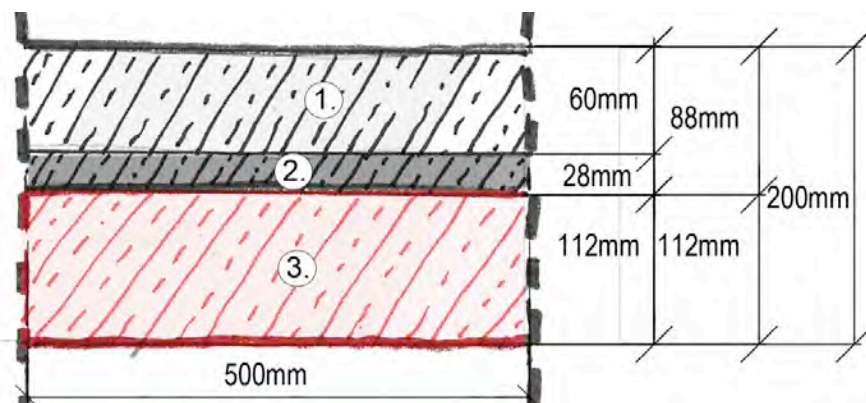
Durchschnittliche Betonmenge, = 88mm Beton Bestand und 112mm Beton Neu,
